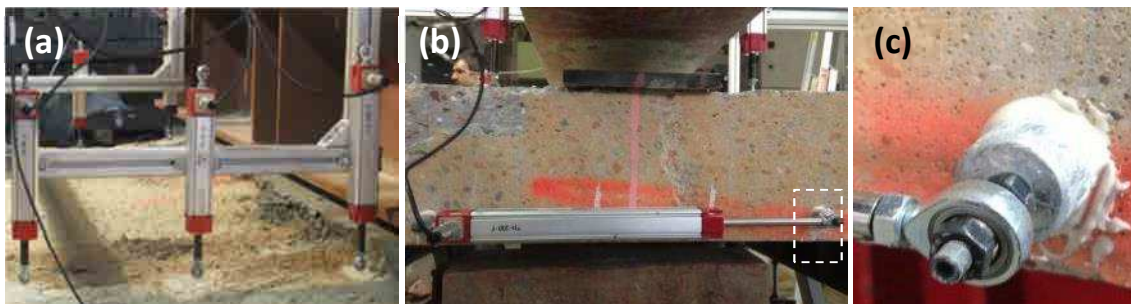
a) y b) Colocación de LVDTs, c) Detalle adhesivo X60
